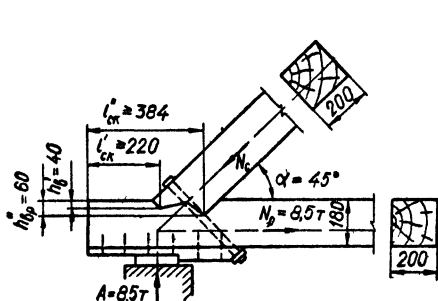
Деталь лобовой врубки с двумя зубьями.
